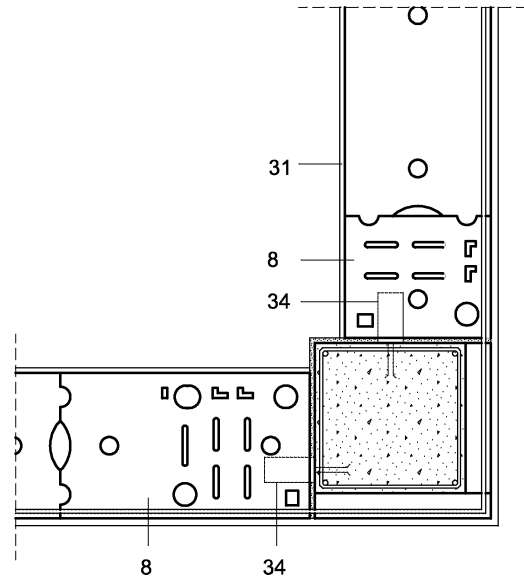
Encuentro con pilar en esquina hilada par. Muro portante. Bloque de longitud 50.
